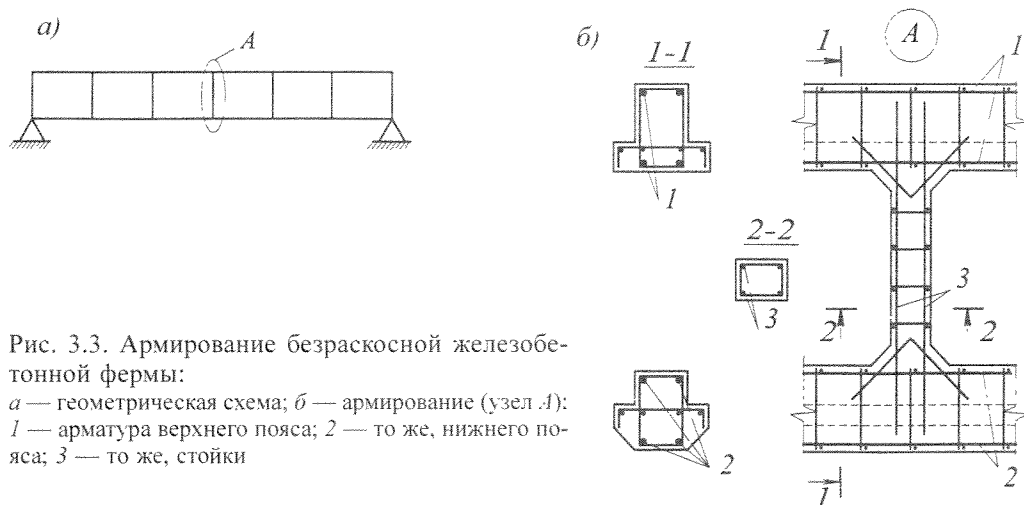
Армирование безраскосной железобетонной фермы:
